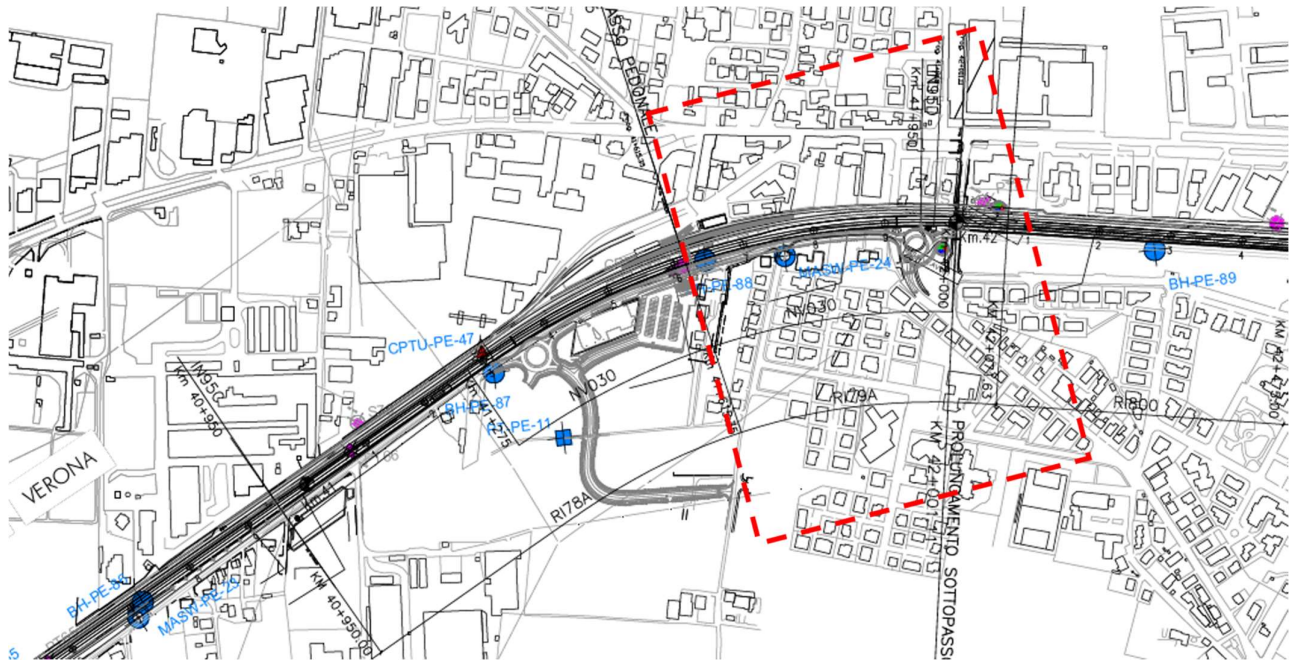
Planimetria Rilevato R179A, estratto dalla Planimetria Generale (Doc. Rif.[3])
